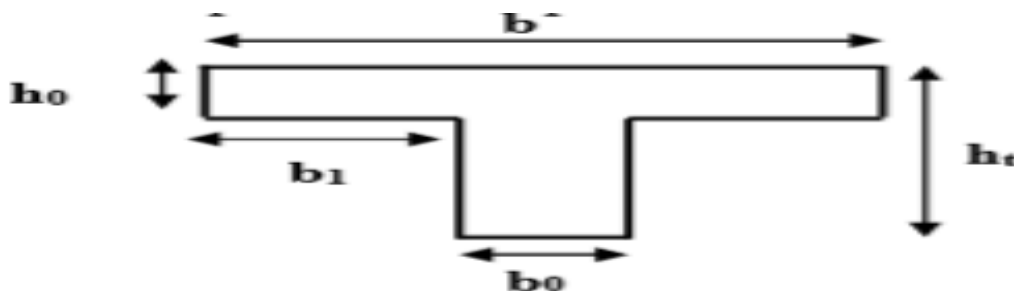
Schéma de calcul d'un plancher à corps creux
